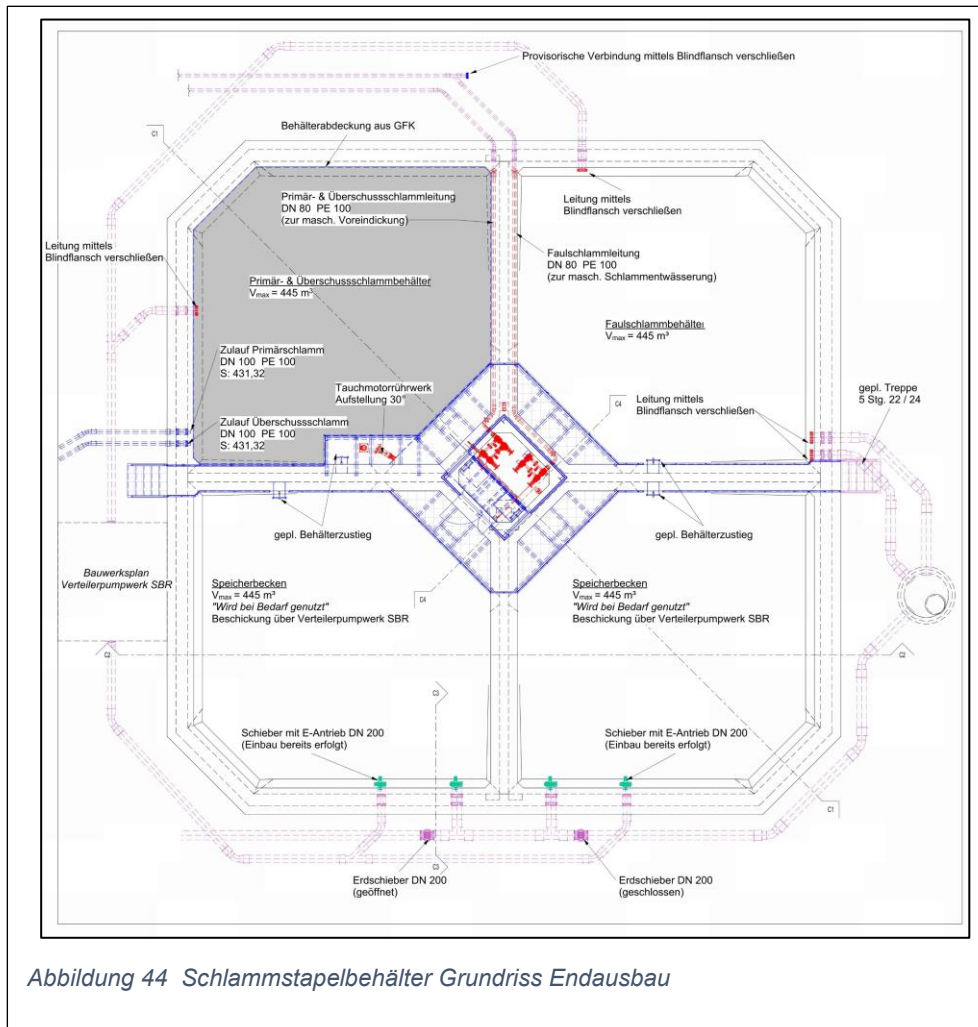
Schlammstapelbehälter Grundriss Endausbau
